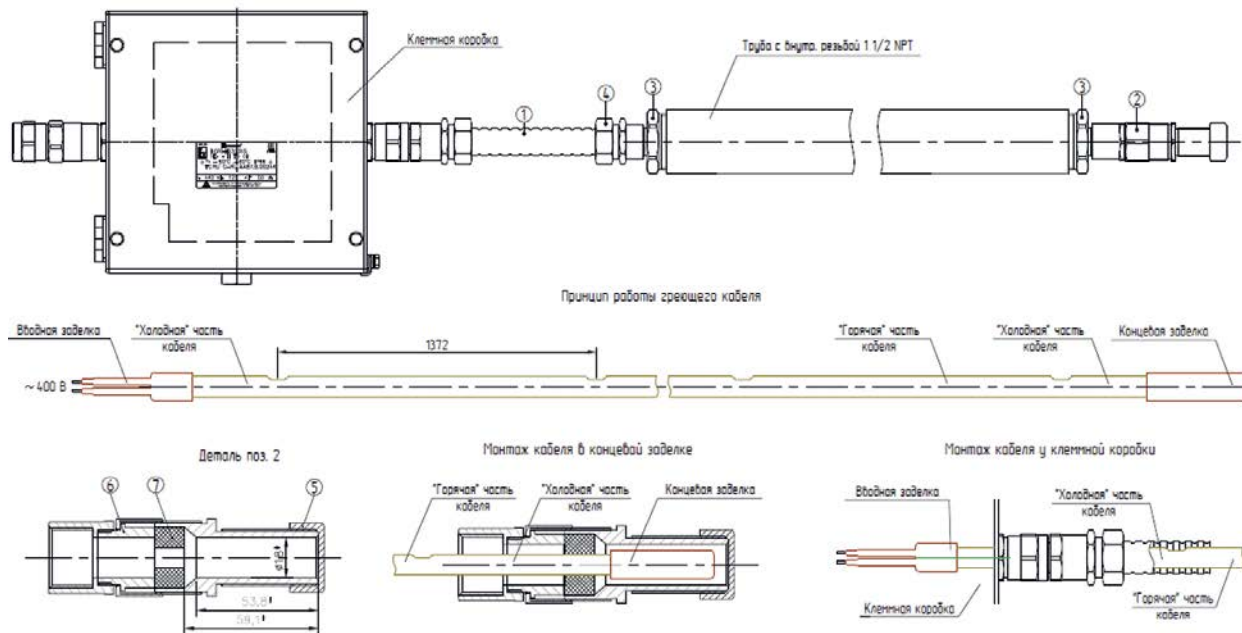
Пример чертежа установки нагревательного кабеля, где 1 – металлорукав; 2 – кабельный элемент для заделки нагревательного кабеля; 3 – переходник; 4 – фитинг с внутренней резьбой для присоединения металлорукава; 5 – заглушка с внутренней резьбой M25 x 1,5; 6 – кабельный ввод для небронированного кабеля; 7 – уплотнение под нагревательный кабель
